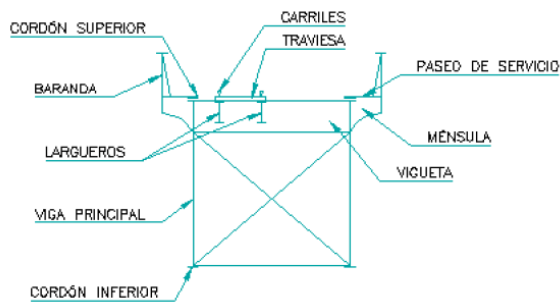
Sección transversal del tablero del viaducto sobre barranco Mascarat
